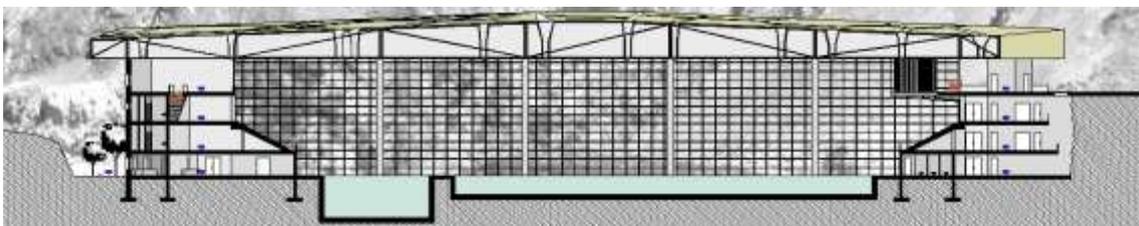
Secção AA, envidraçado e estrutura metálica.
